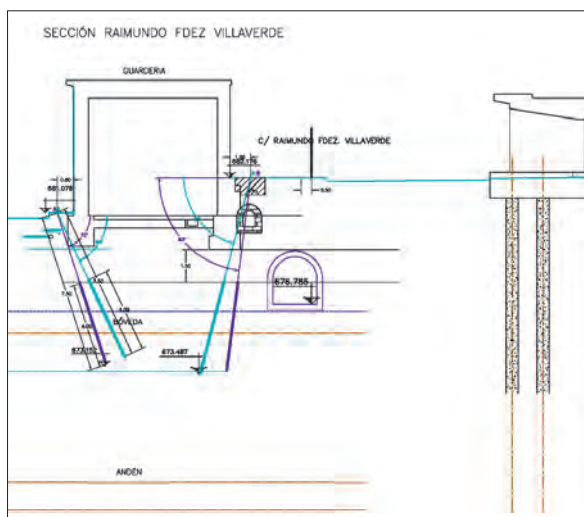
SECCIÓN TRANSVERSAL A LA GUARDERÍA CON LOS TALADROS DE INYECCIÓN.
